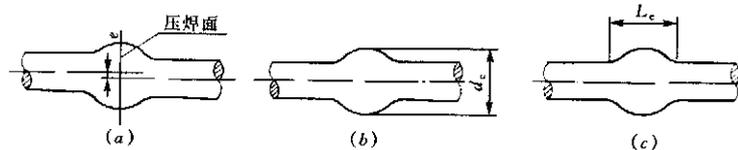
钢筋气压焊接外观质量图解
